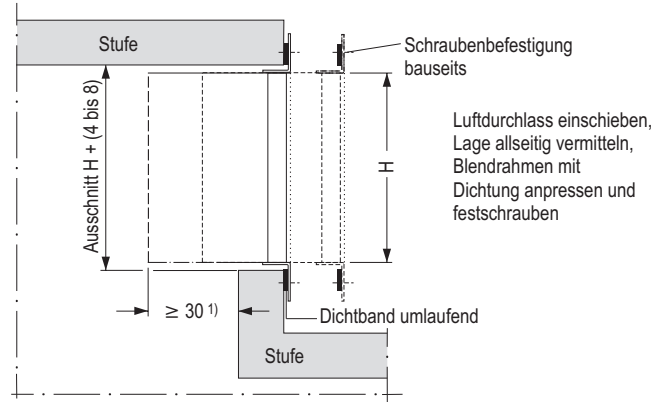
Ausführung mit Blendrahmen für Schraubenbefestigung
